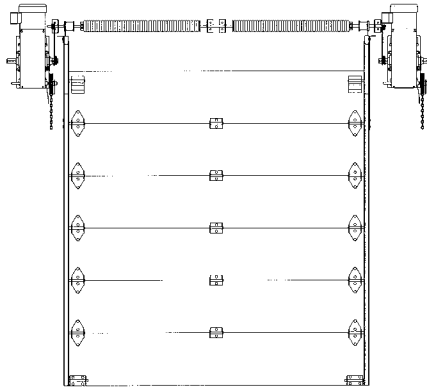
Installation murale à droite ou à gauche (Palan à droite)
